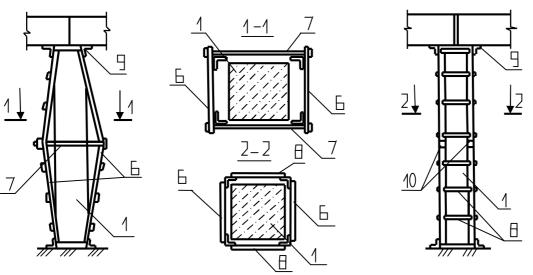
Усиление железобетонной колонны: а) с помощью устройства железобетонной обоймы; б) с помощью двусторонних распорок;
